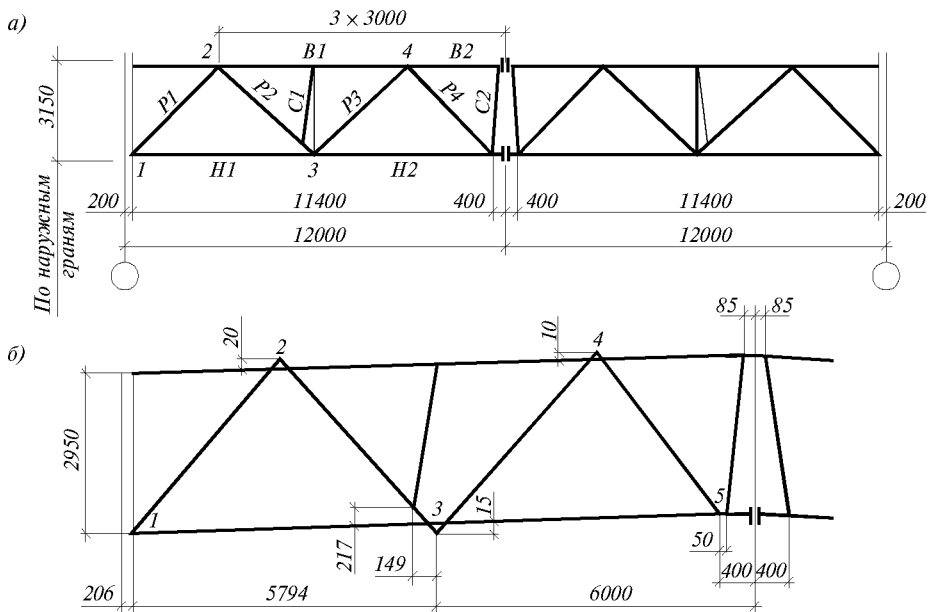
Расчетная схема стропильной фермы с поясами из широкополочных двутавров
